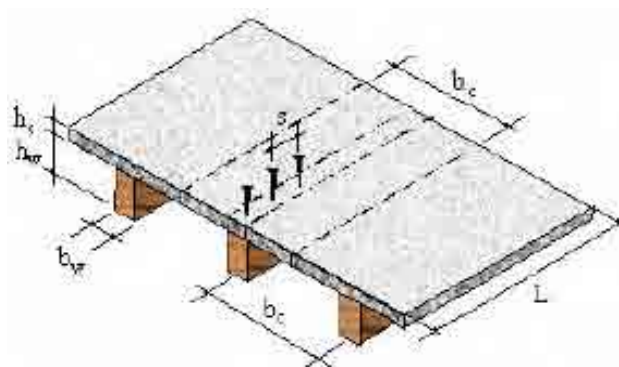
Arranjo típico de um piso de madeira-concreto. *Fonte: ALVIM & ALMEIDA (2003)
